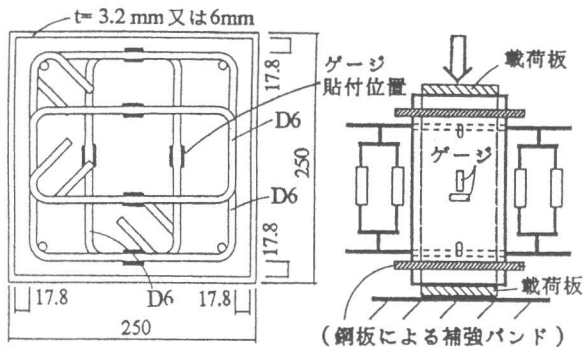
試験体の断面詳細図，帯筋のひずみゲージ貼付位置，載荷及び測定方法
